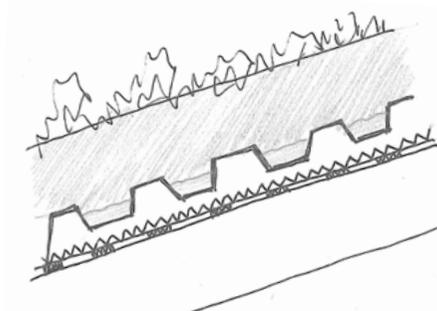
Cubierta inclinada 10-25° con capa drenante.
